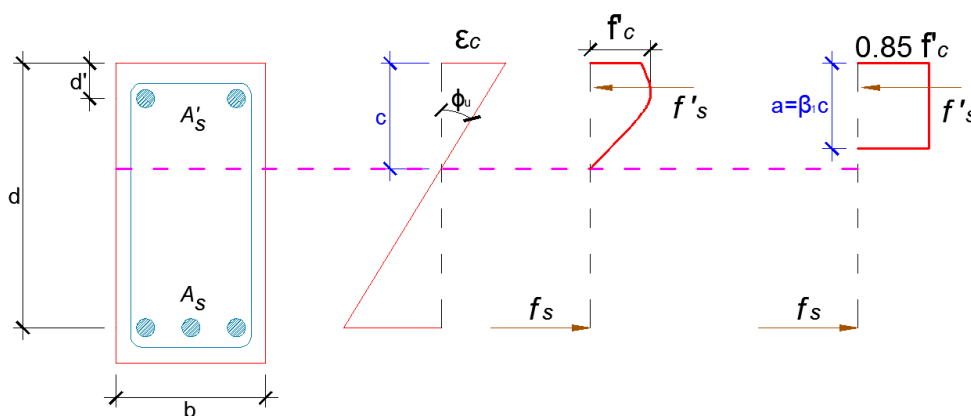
Viga de concreto armado en estado último por flexión (Wakabayashi y Martínez, 1988).
